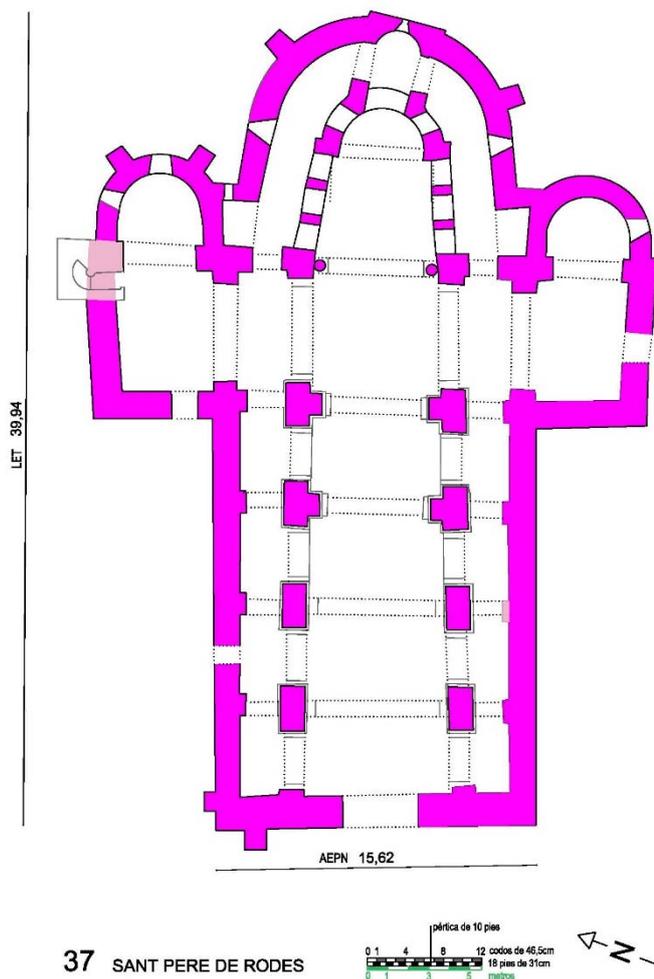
Planta crono-cromática de St. Pere. Elaborada por autora.
